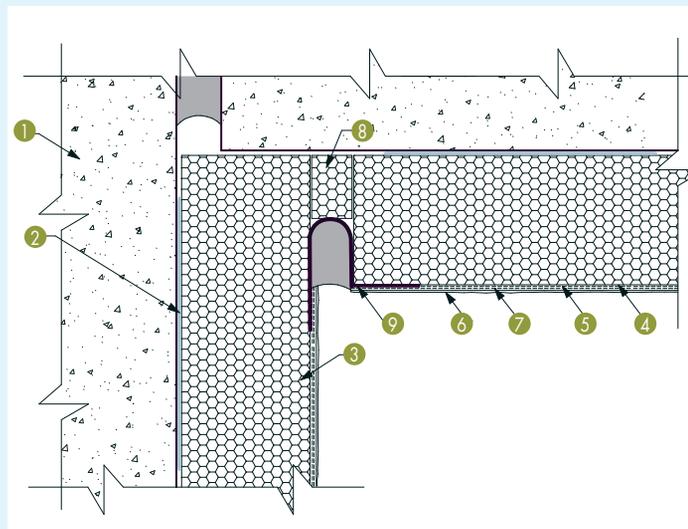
Joint de dilatation - angle rentrant (coupe horizontale)
